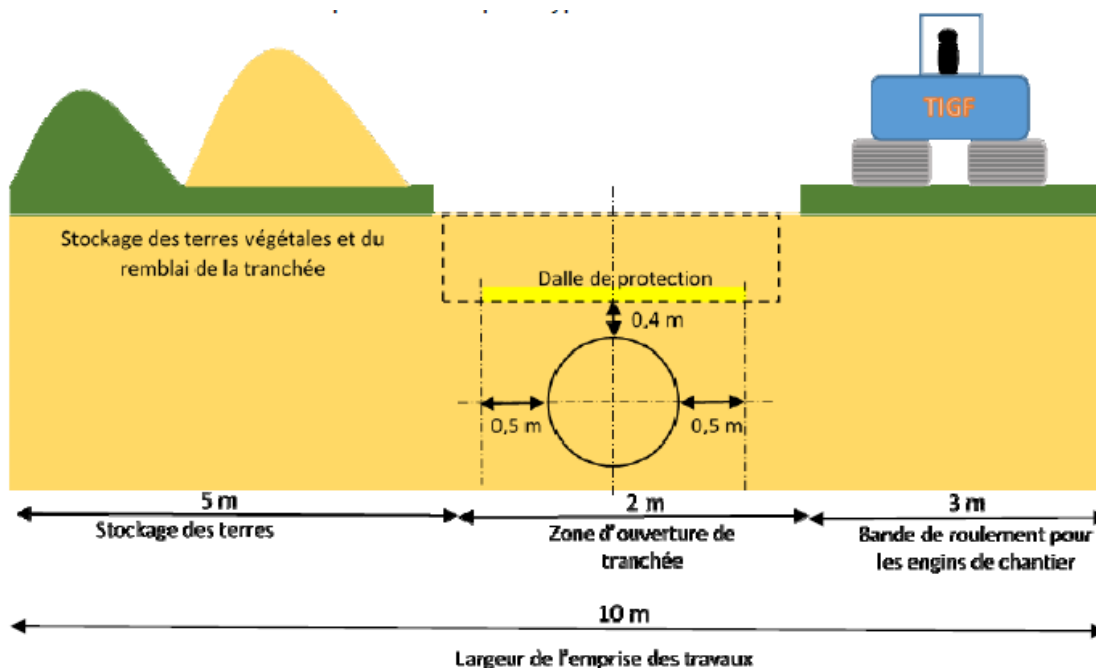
travaux de terrassement pour pose de dalles de protection (source : étude d'impact).
